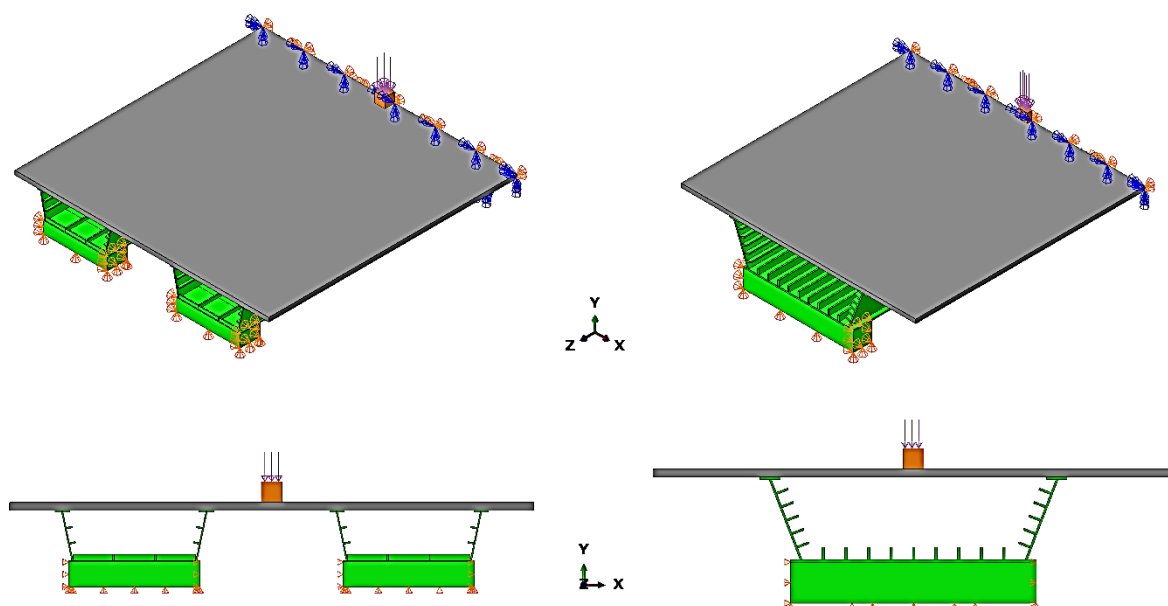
Restrições e forma de aplicação de carga nos modelos com carregamento pontual.
